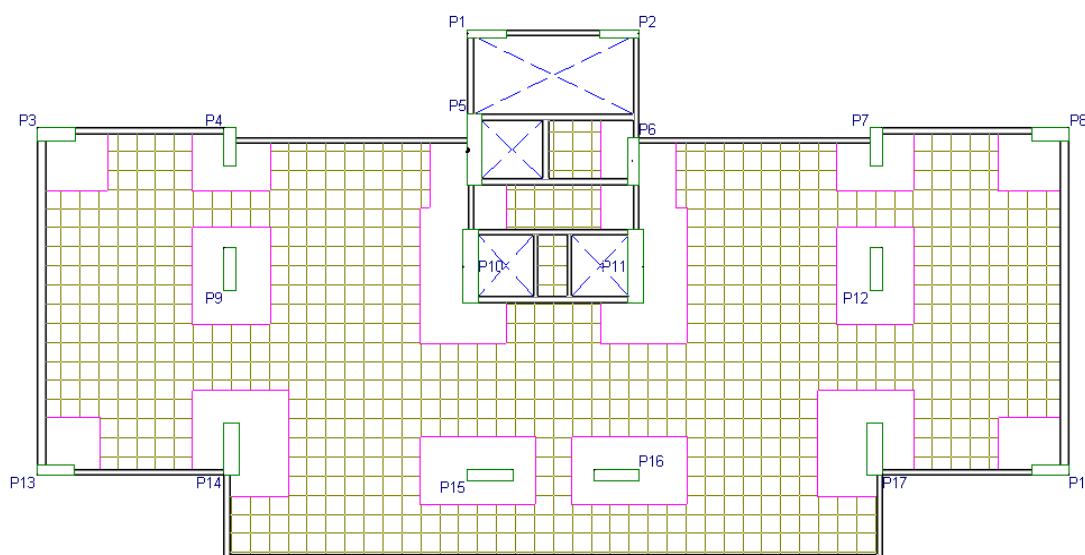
Planta baixa lançamento 4 (AUTORES (2020))
